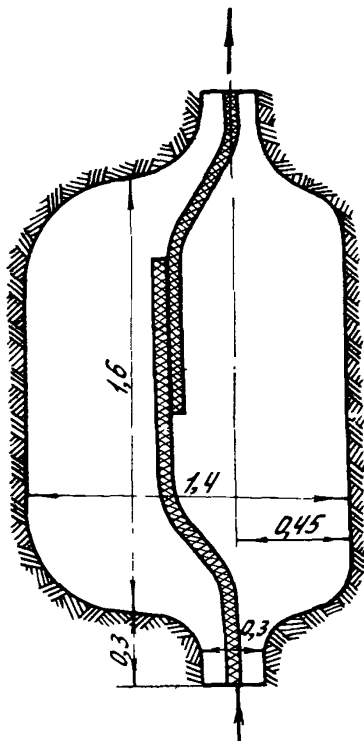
Котлован для монтажа муфт с выкладкой кабеля
